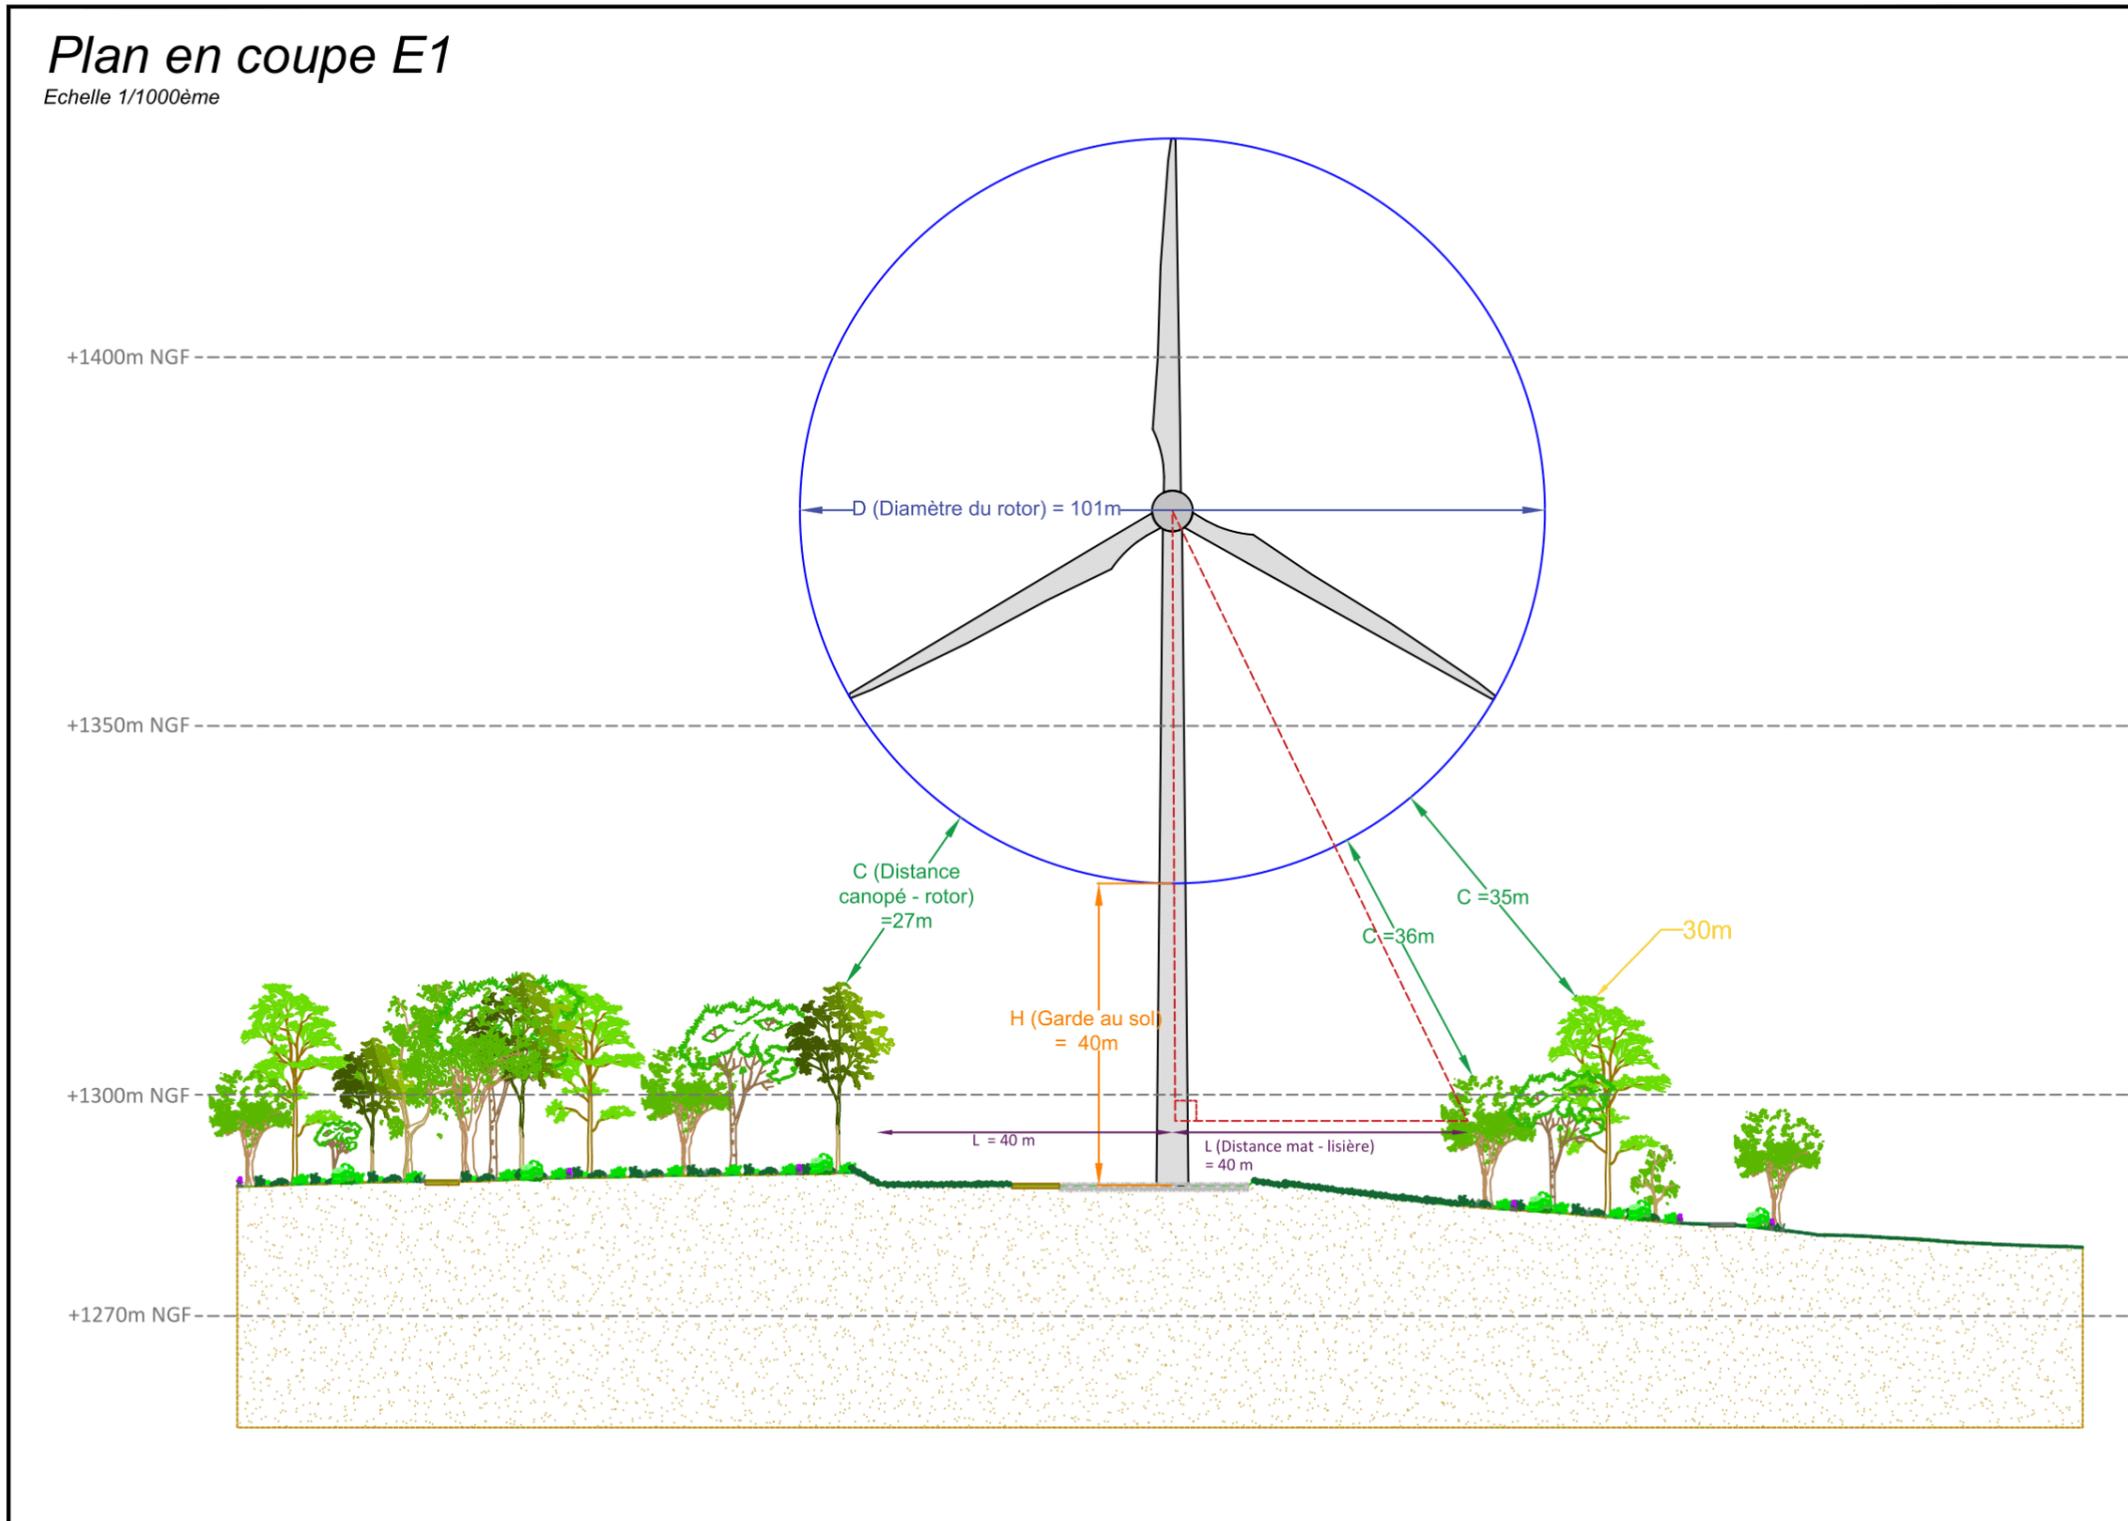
Plan de coupe et distance aux lisières (éolienne E1)
